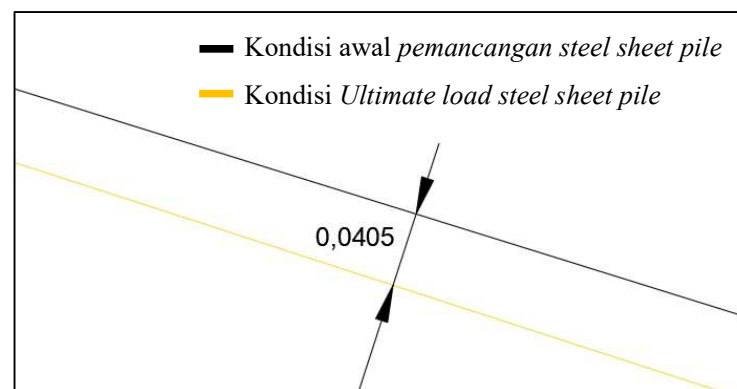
33 Koordinat Titik *Steel Sheet Pile
